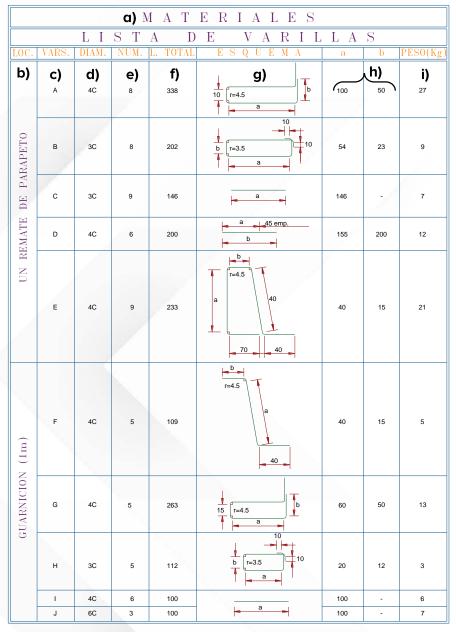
Ejemplo de la tabla de la lista de varillas en el plano del parapeto
